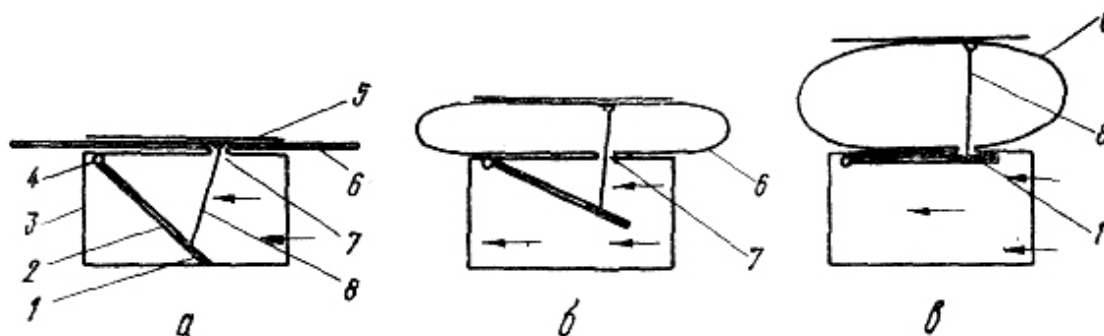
Принципиальная схема устройства для предохранения гибких вентиляционных труб от механических повреждений при пуске вентилятора:
